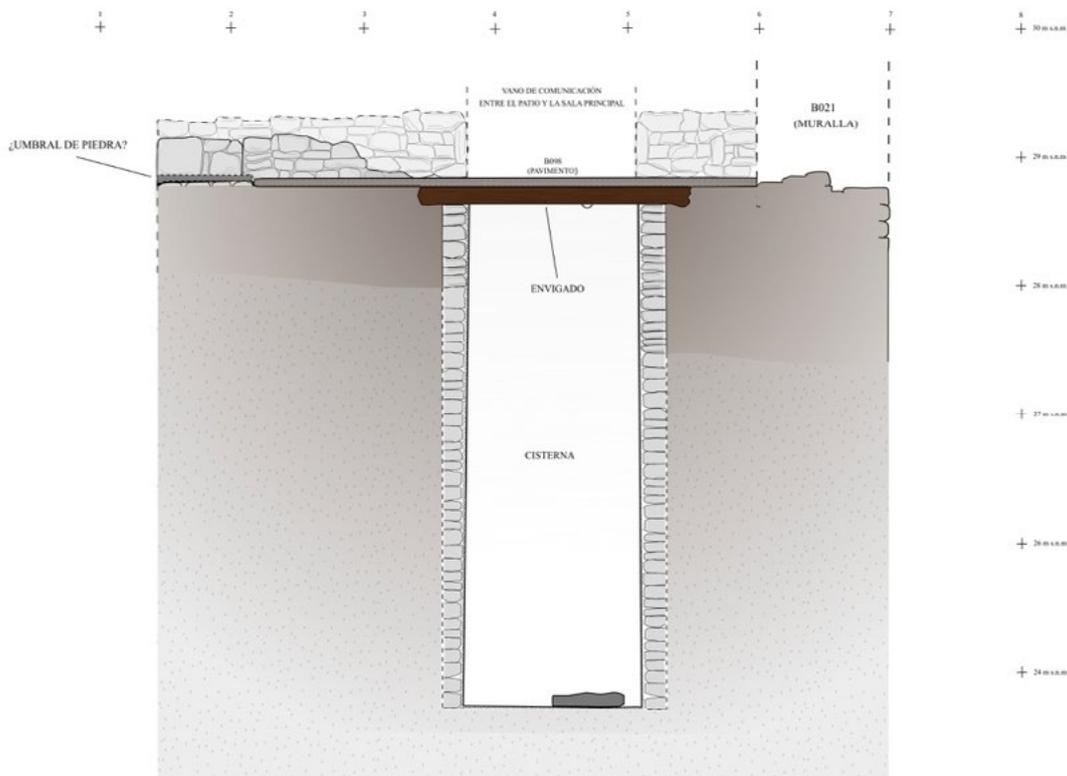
Sección transversal de la cisterna (hacia el norte) con restitución de viga y pavimento en sala B.
